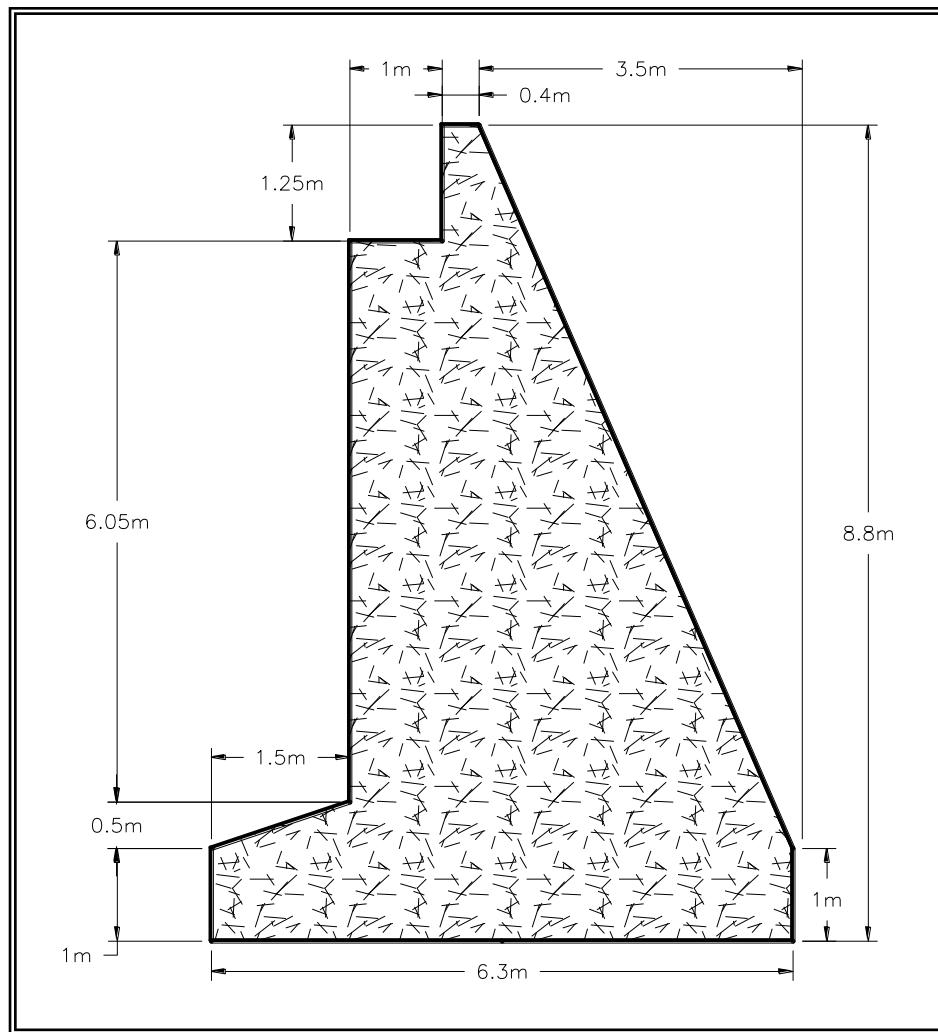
97 Geom etría del muro de m am postería a diseñ ar.
